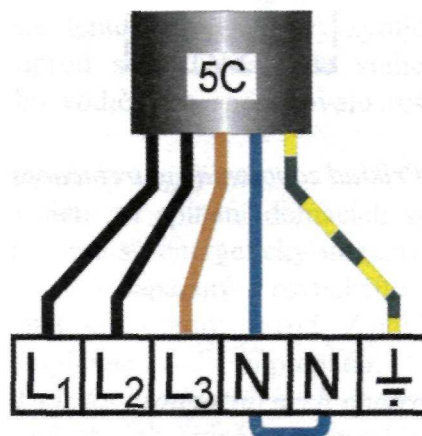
Príklad zapojenia spotrebiča v sieti TN – C
